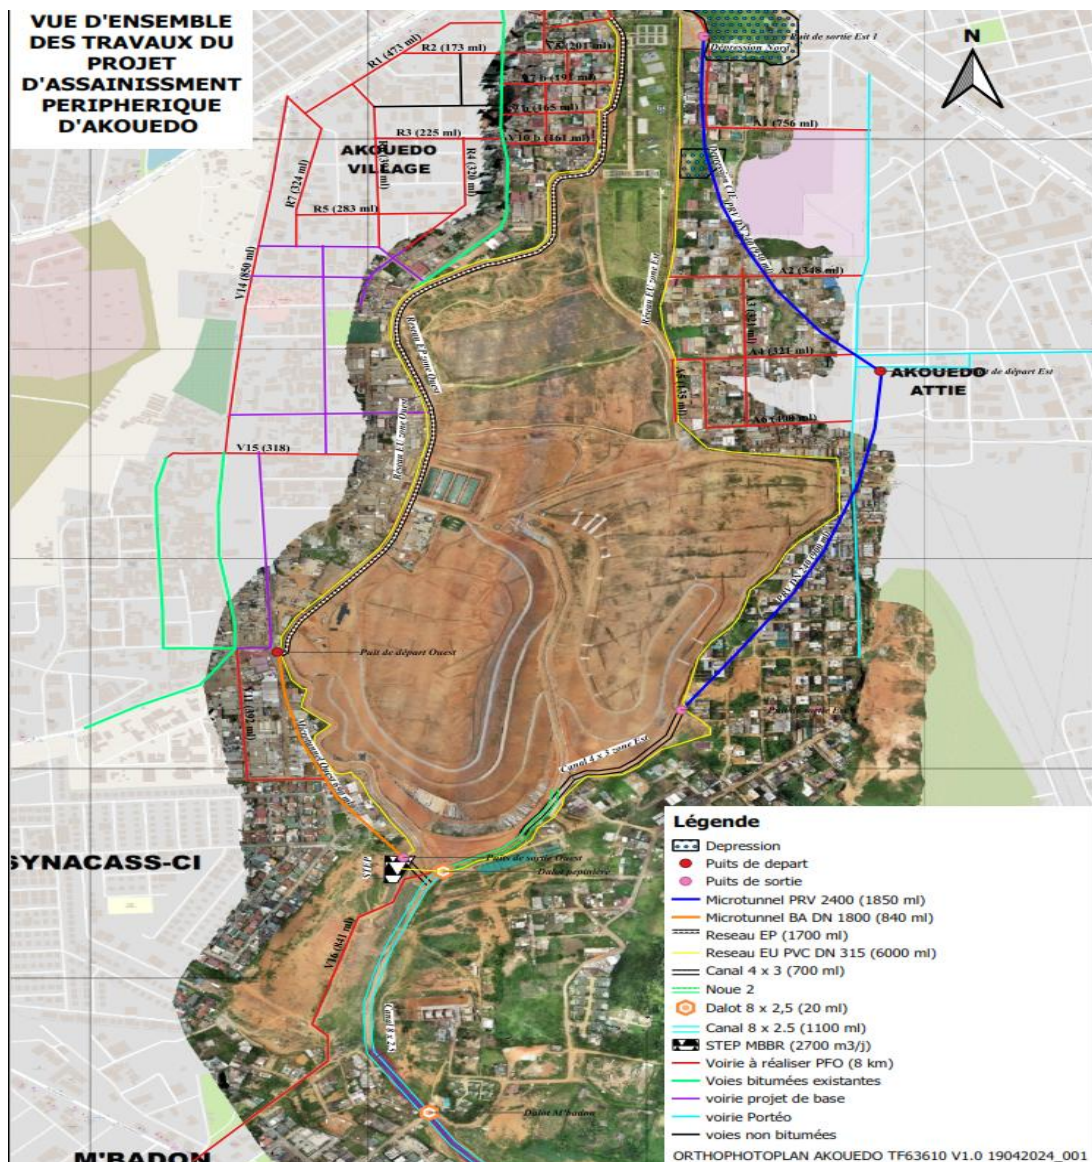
Vue d'ensemble des travaux du projet d'assainissement périphérique d'Akouédo. (Source : PFO, 2025)
